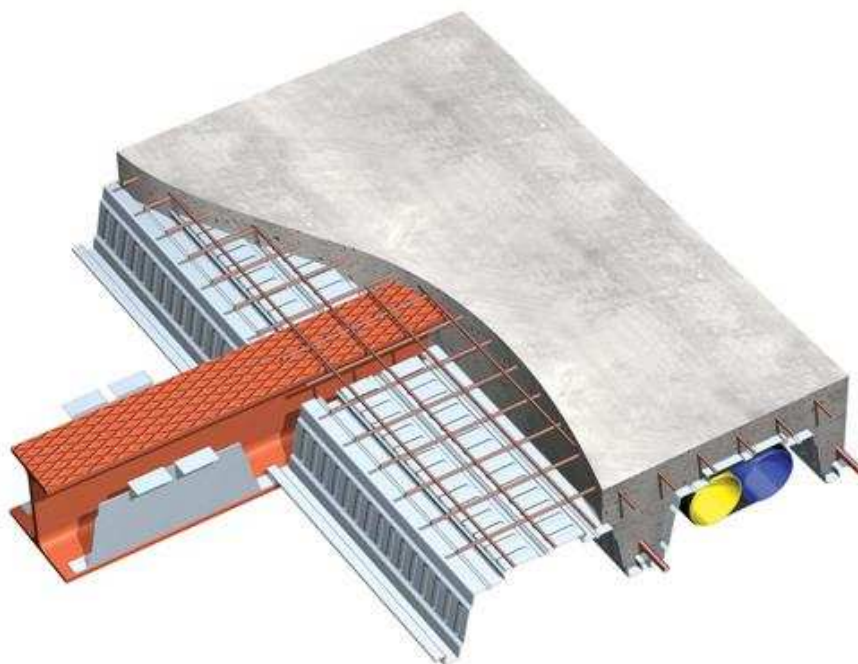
Esquema de uma viga de *slim floor* do tipo ASB, detalhe para o perfil envolvido pela laje de concreto (STEEL CONSTRUCTION, 2015).
